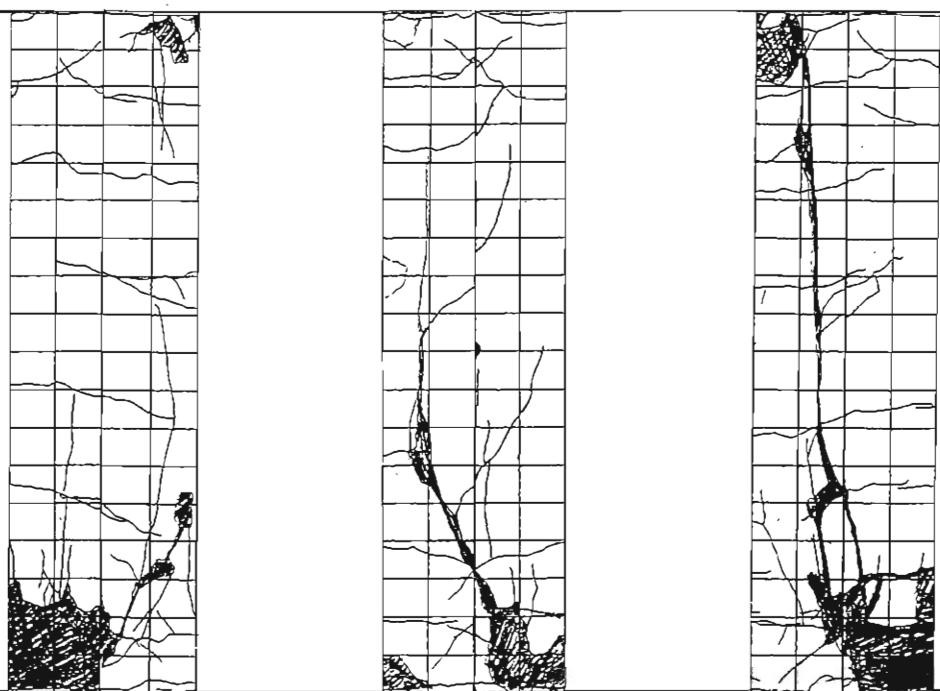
桁体のひび割れ状況展開図（ケース3、 $2 \delta y$ ）
